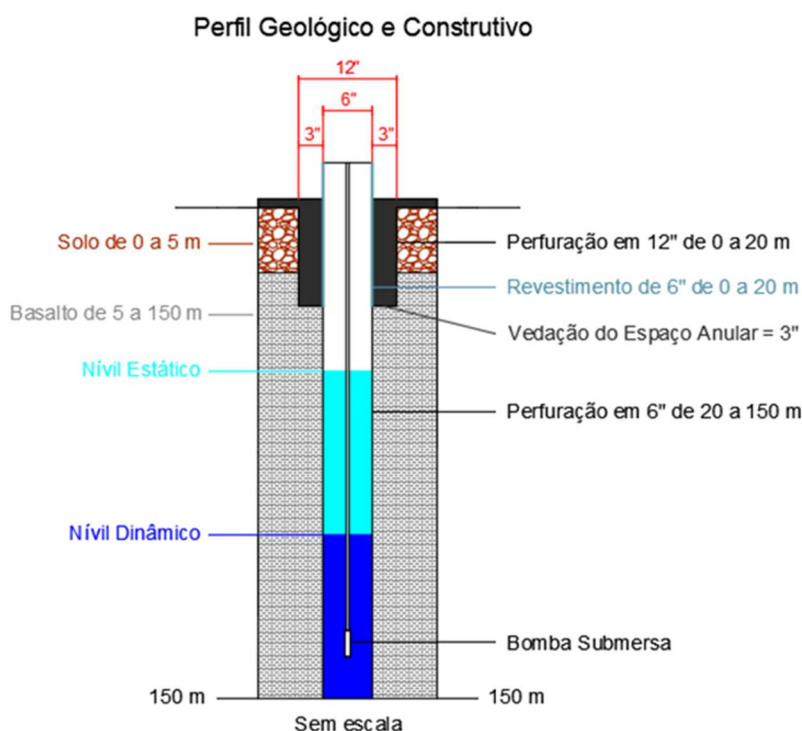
Perfil Geológico e Construtivo do Poço. Fonte: Autor (2026).
